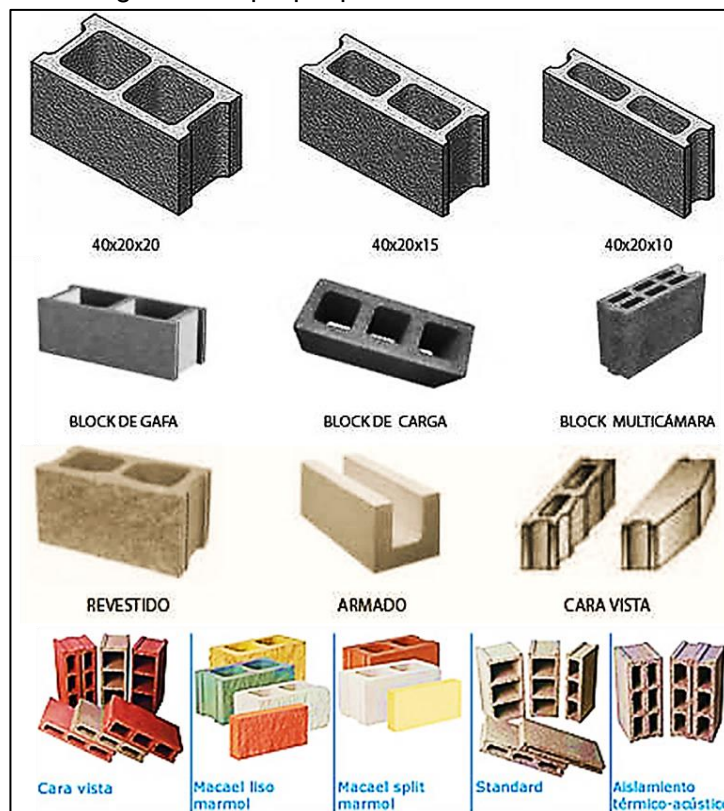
Tipos de bloques de hormigón. (Bloques de Concreto: Historia y Diseño de los bloques de concreto, 2019)
